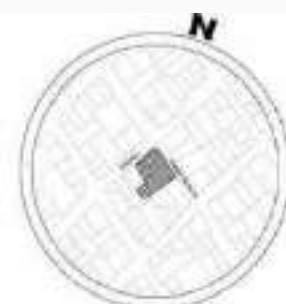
Anexo plano de ubicación de la casa Villacís. Nota: Foto de la autora (2019).
